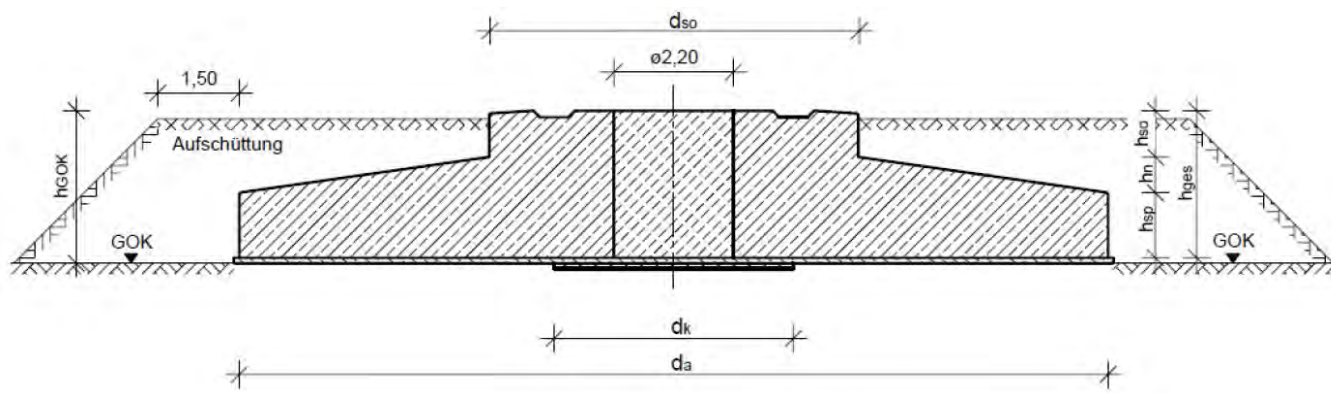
Plan des fondations pour les éoliennes de type E-138-EP3 – 180m
